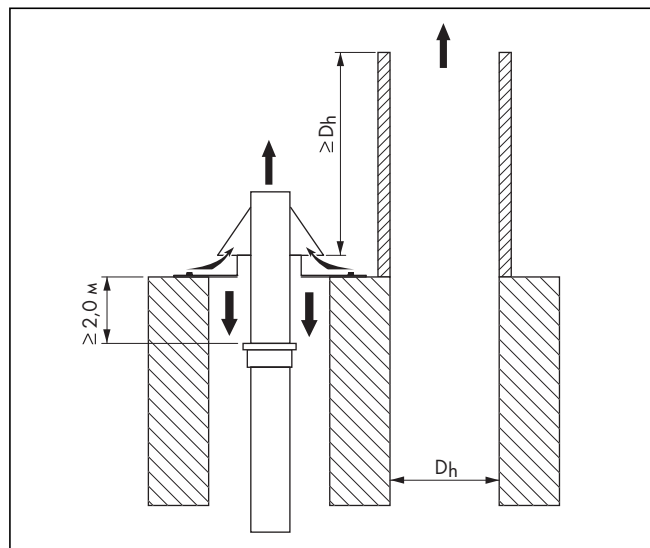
Высота дымовой трубы над выпускным газопроводом из ПП с устьем из нержавеющей стали - с забором воздуха не из помещения
